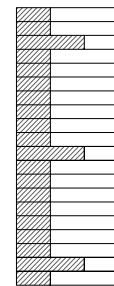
Sección de muro doblado de 1,5 pies de espesor.
